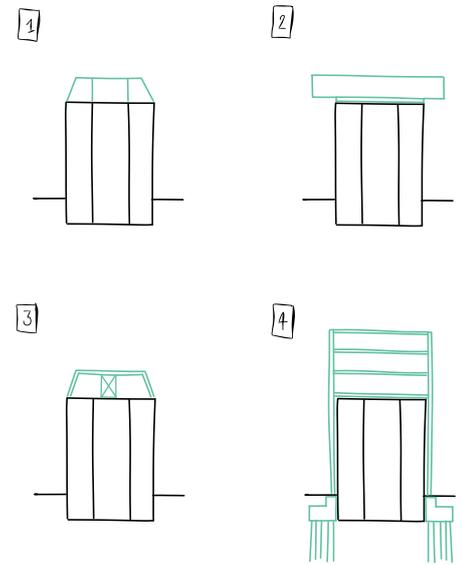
Vier Tragwerksansätze für den Dachaufbau
